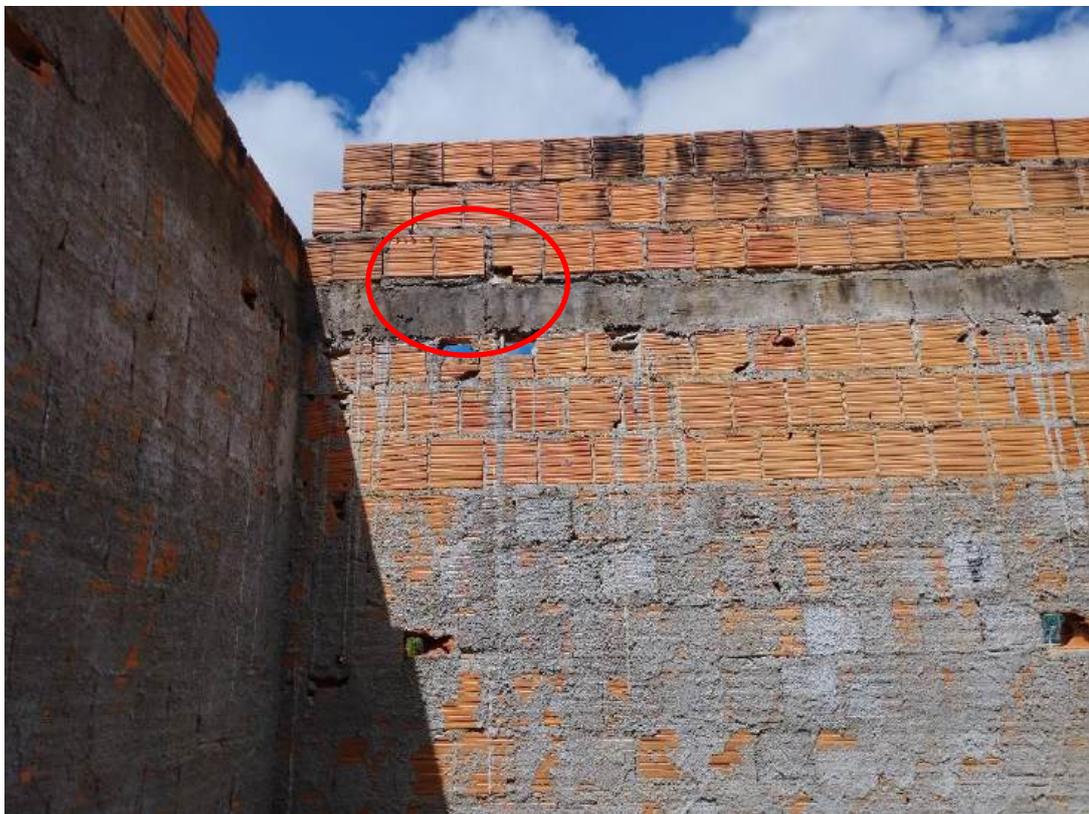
Ferragens expostas, quebra de seções da viga com tubulações
